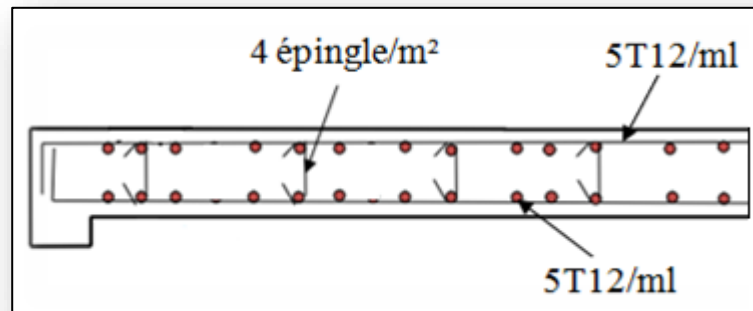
Schéma de ferrailage d'un trumeau.
